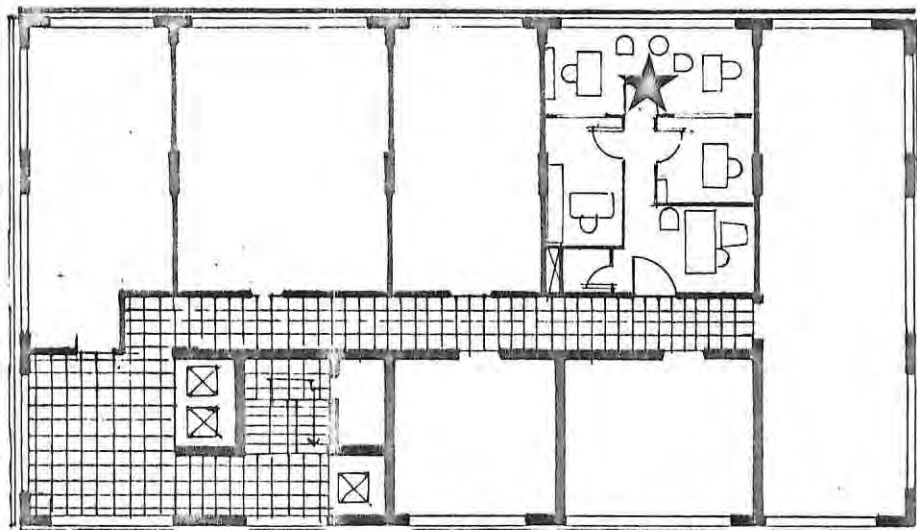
Planta del 8º piso, lugar de origen del fuego.
